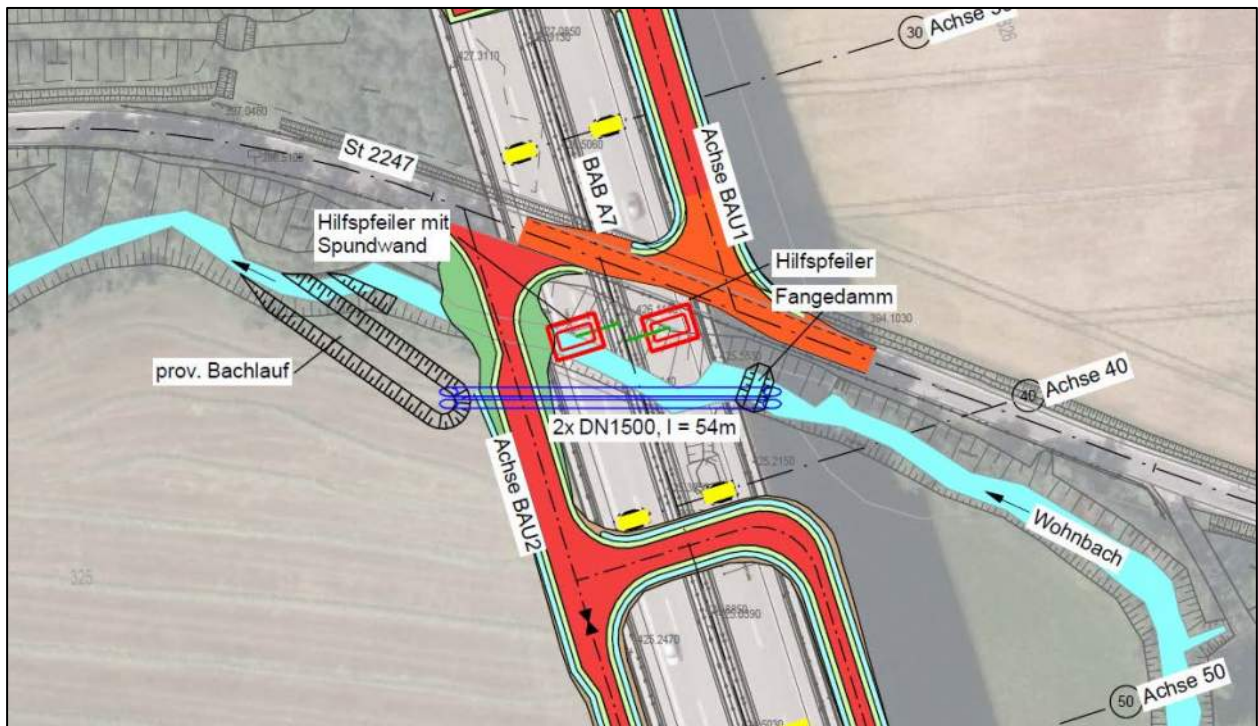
Ausschnitt Lageplan<sup>2</sup> des Bauzustandes „Verrohrung Wohnbach“
